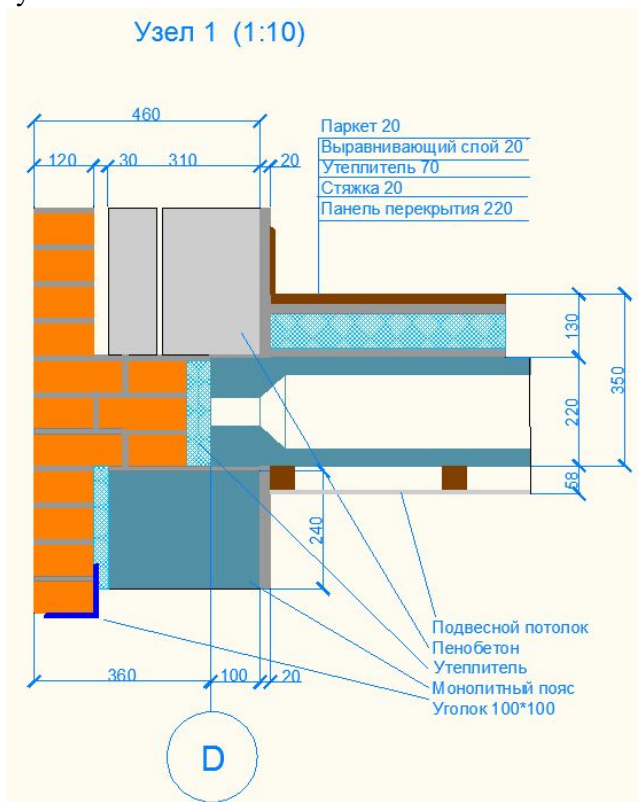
Креслення вузла примикання перекриття до зовнішньої стіни
